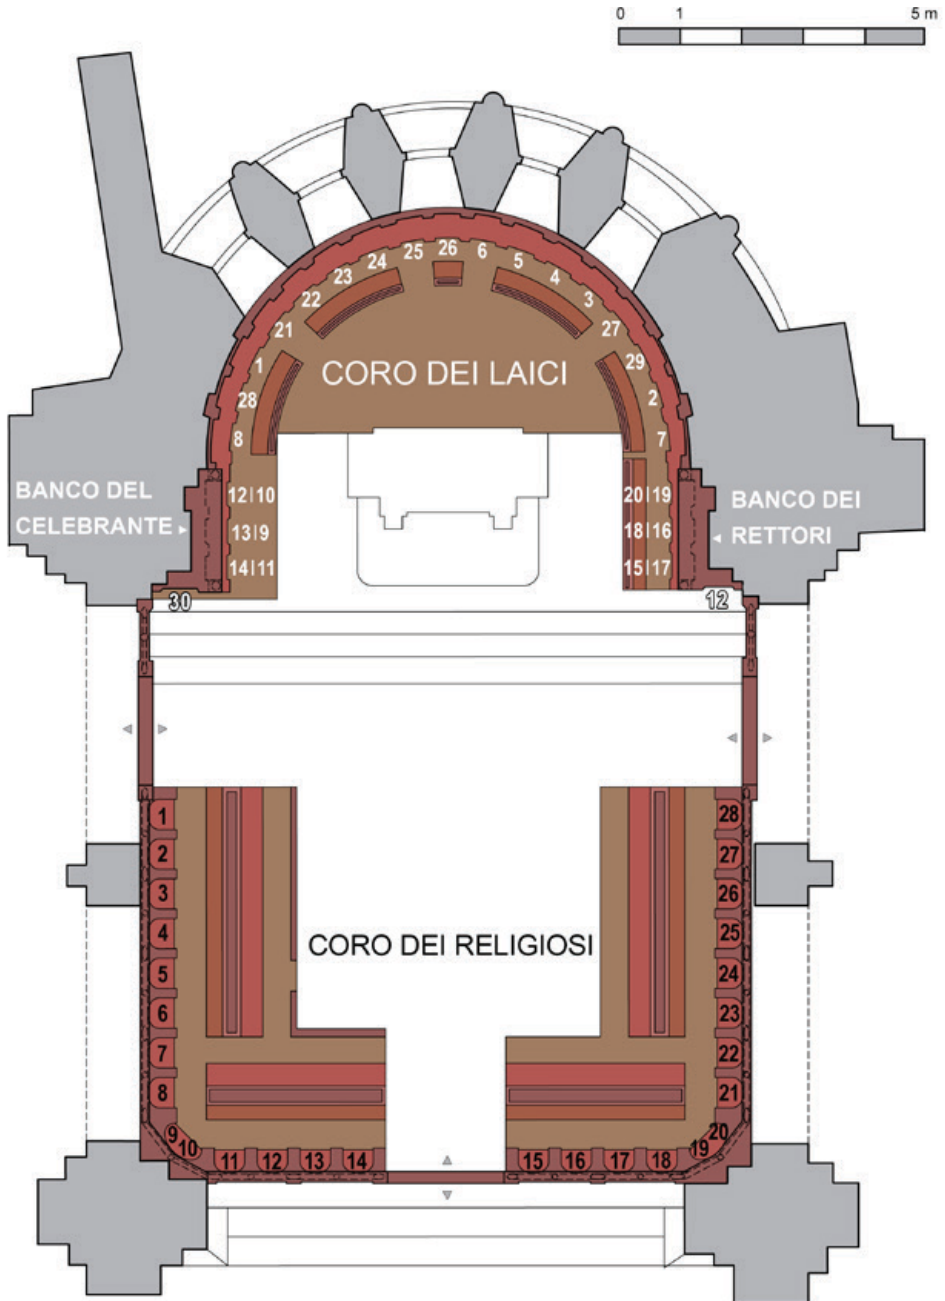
/ Disposizione delle tarsie di Lotto e Capoferrì. Nel coro dei laici la disposizione attuale, nel coro dei religiosi la disposizione originale prevista.
